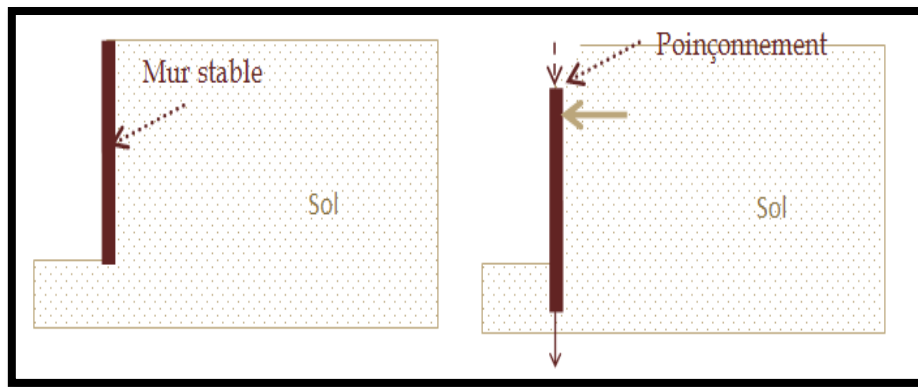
Stabilité au poinçonnement d'un écran de soutènement [3].
